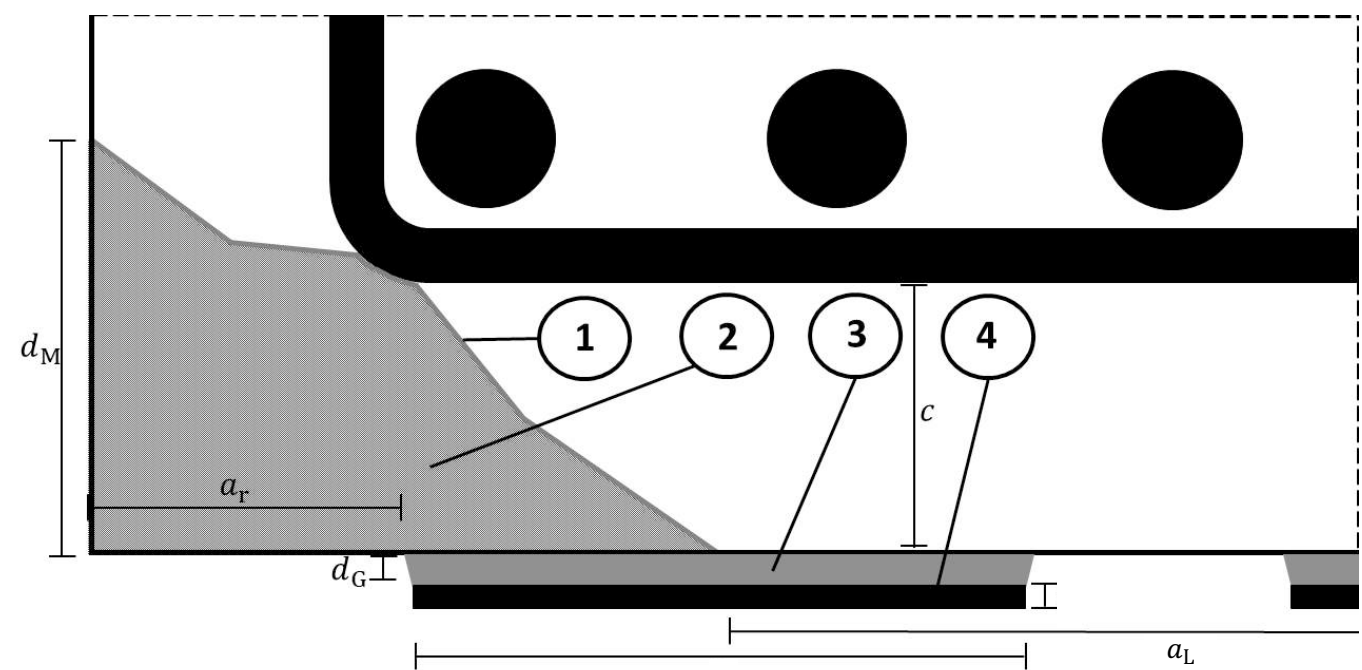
Querschnitt eines Stahlbetonbauteils verstärkt mit schubfest auf die Oberfläche geklebten FRS-L-S und FRS-L-H CFK-Lamellen mit FRS-CS Epoxidharzklebstoff und (optionaler) vorangegangener Betonreparatur mit dem Betonersatzsystem FRS-PC 11 und der Haftbrücke FRS-BA.
